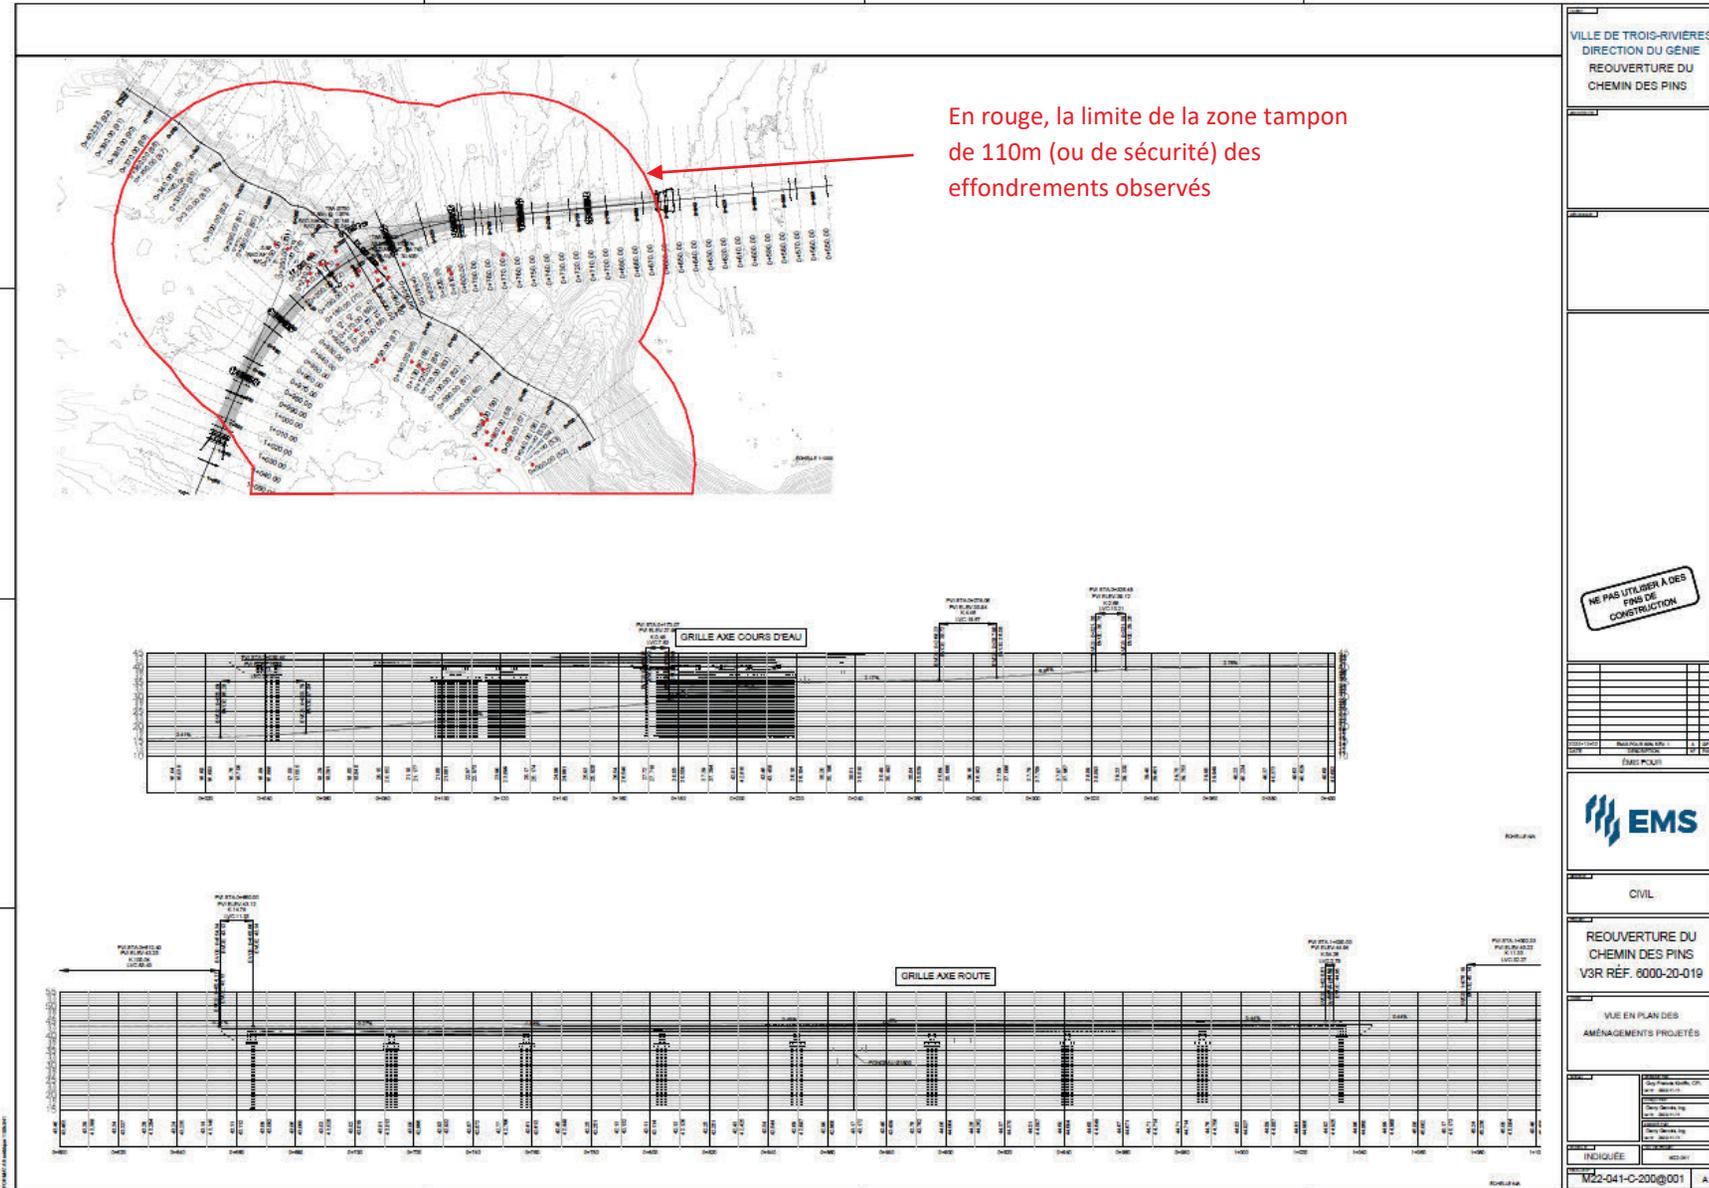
VUE EN PLAN, VUE EN TRAVERS ET PROFILS EN LONG DU PONT PROJÉTÉ
